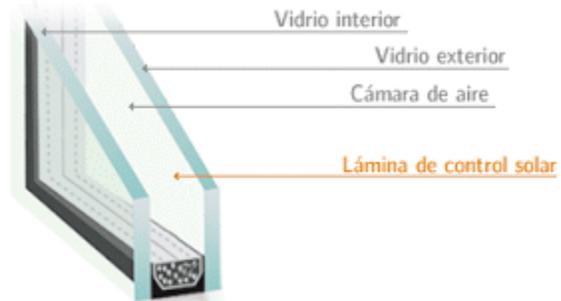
Detalle panel eficiente – Fuente: <http://ecobuildings7.blogspot.com/>
